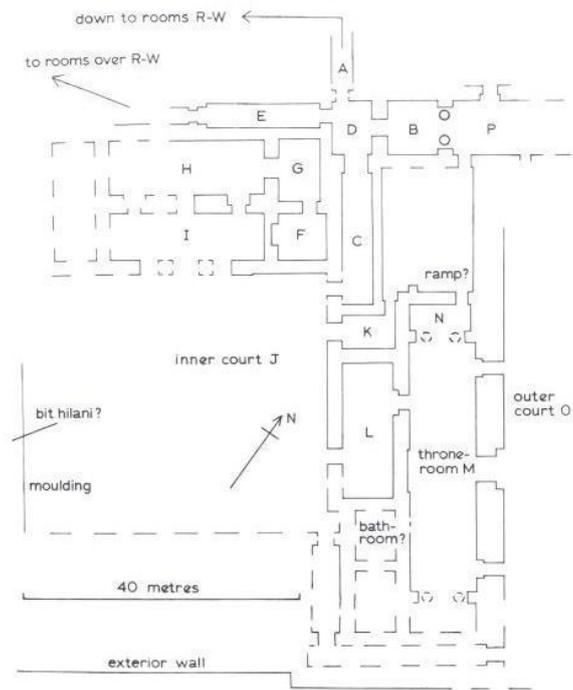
Planta de parte do Palácio Norte de Ashurbanipal.
